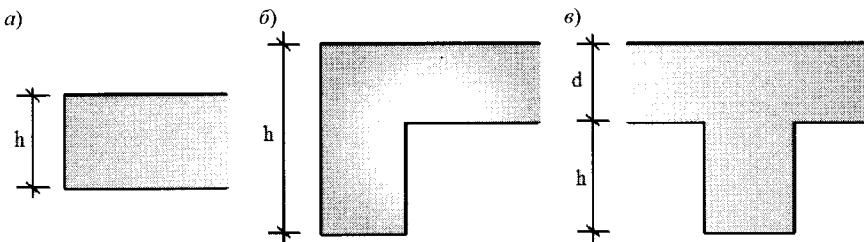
Варианты перекрытий: а - торец перекрытия; б - торец перекрытия с ригелем; в - перекрытие с ригелем
